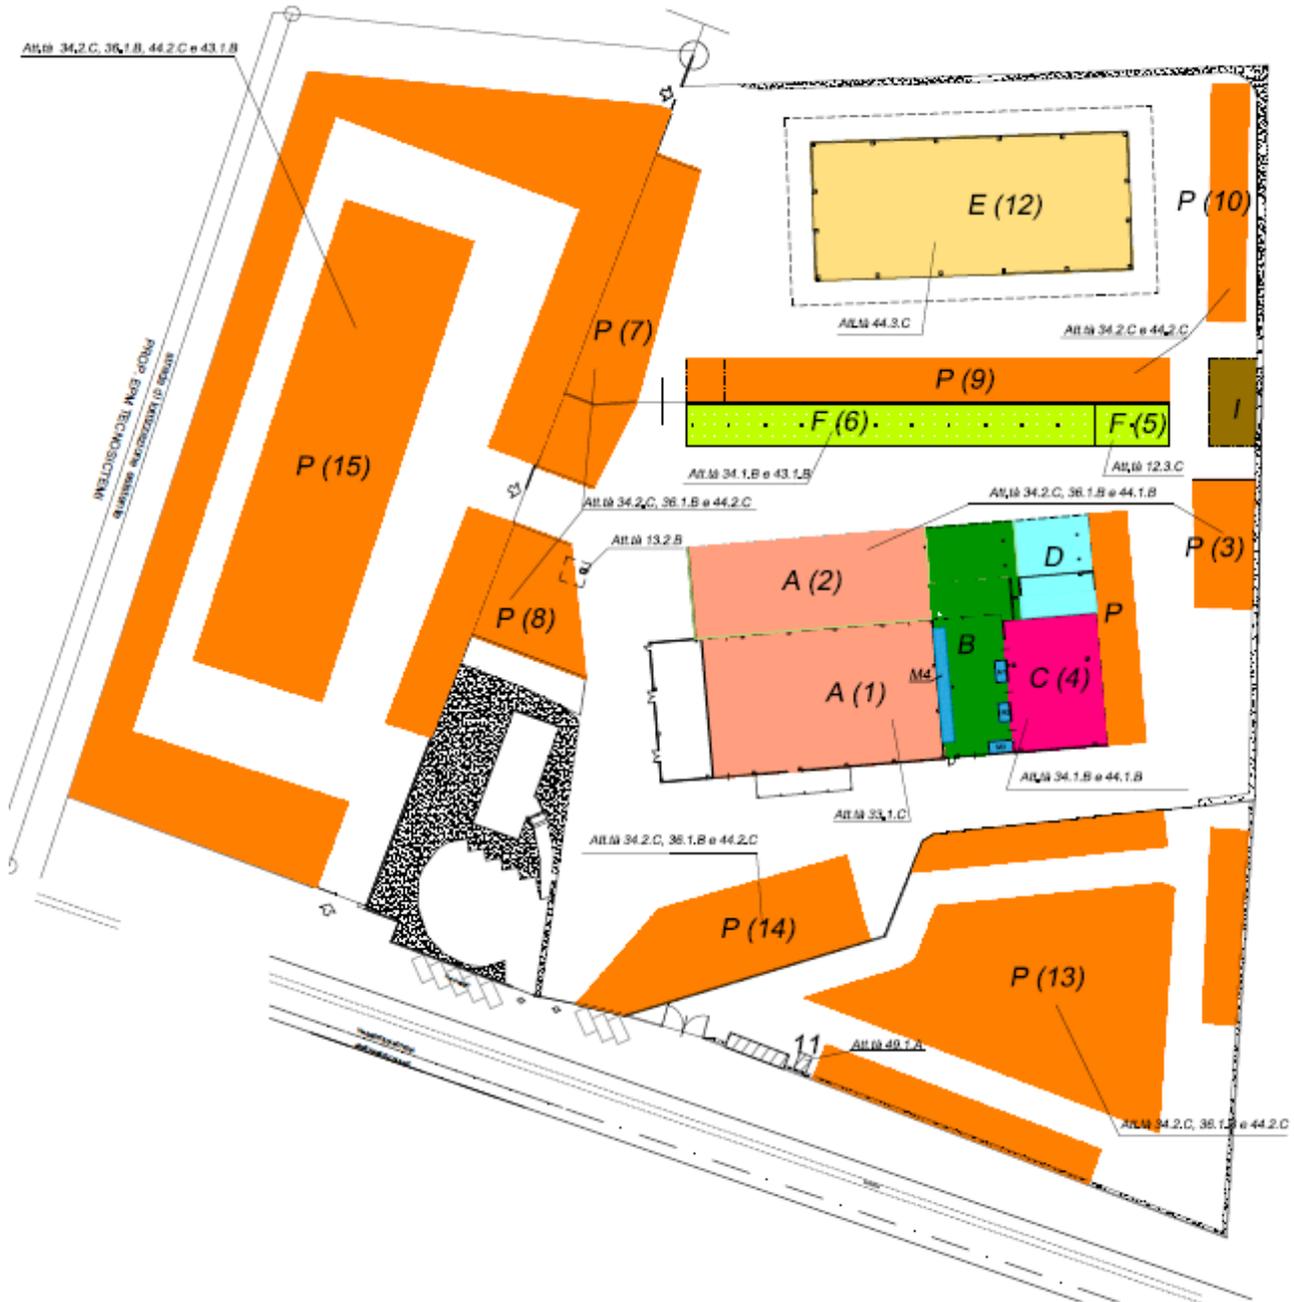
Planimetria stabilimento Refecta, sede operativa del Consorzio Cosmari
